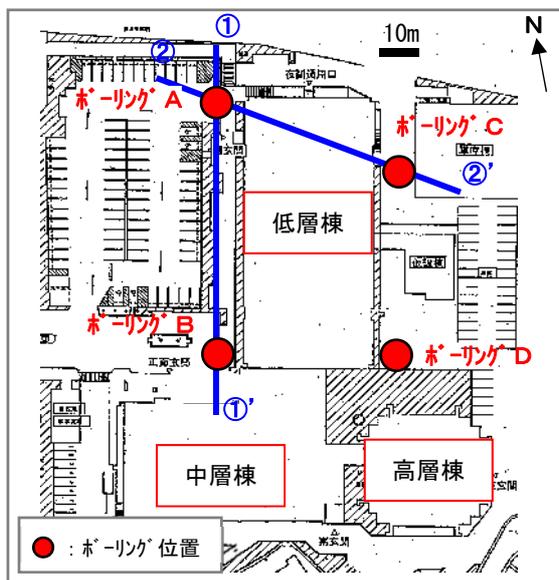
建物平面図(ボーリング位置、断面図ライン併記)
